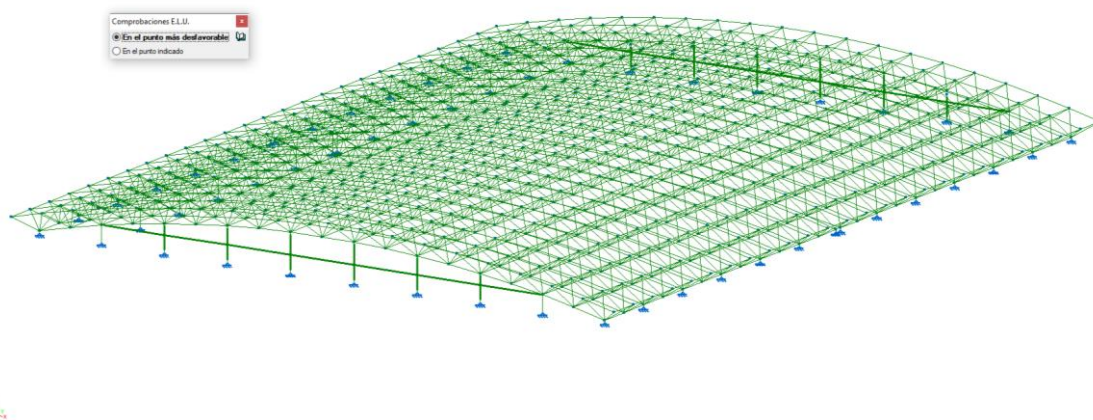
Modelo analítico estructural de la cubierta con el panel sándwich.
